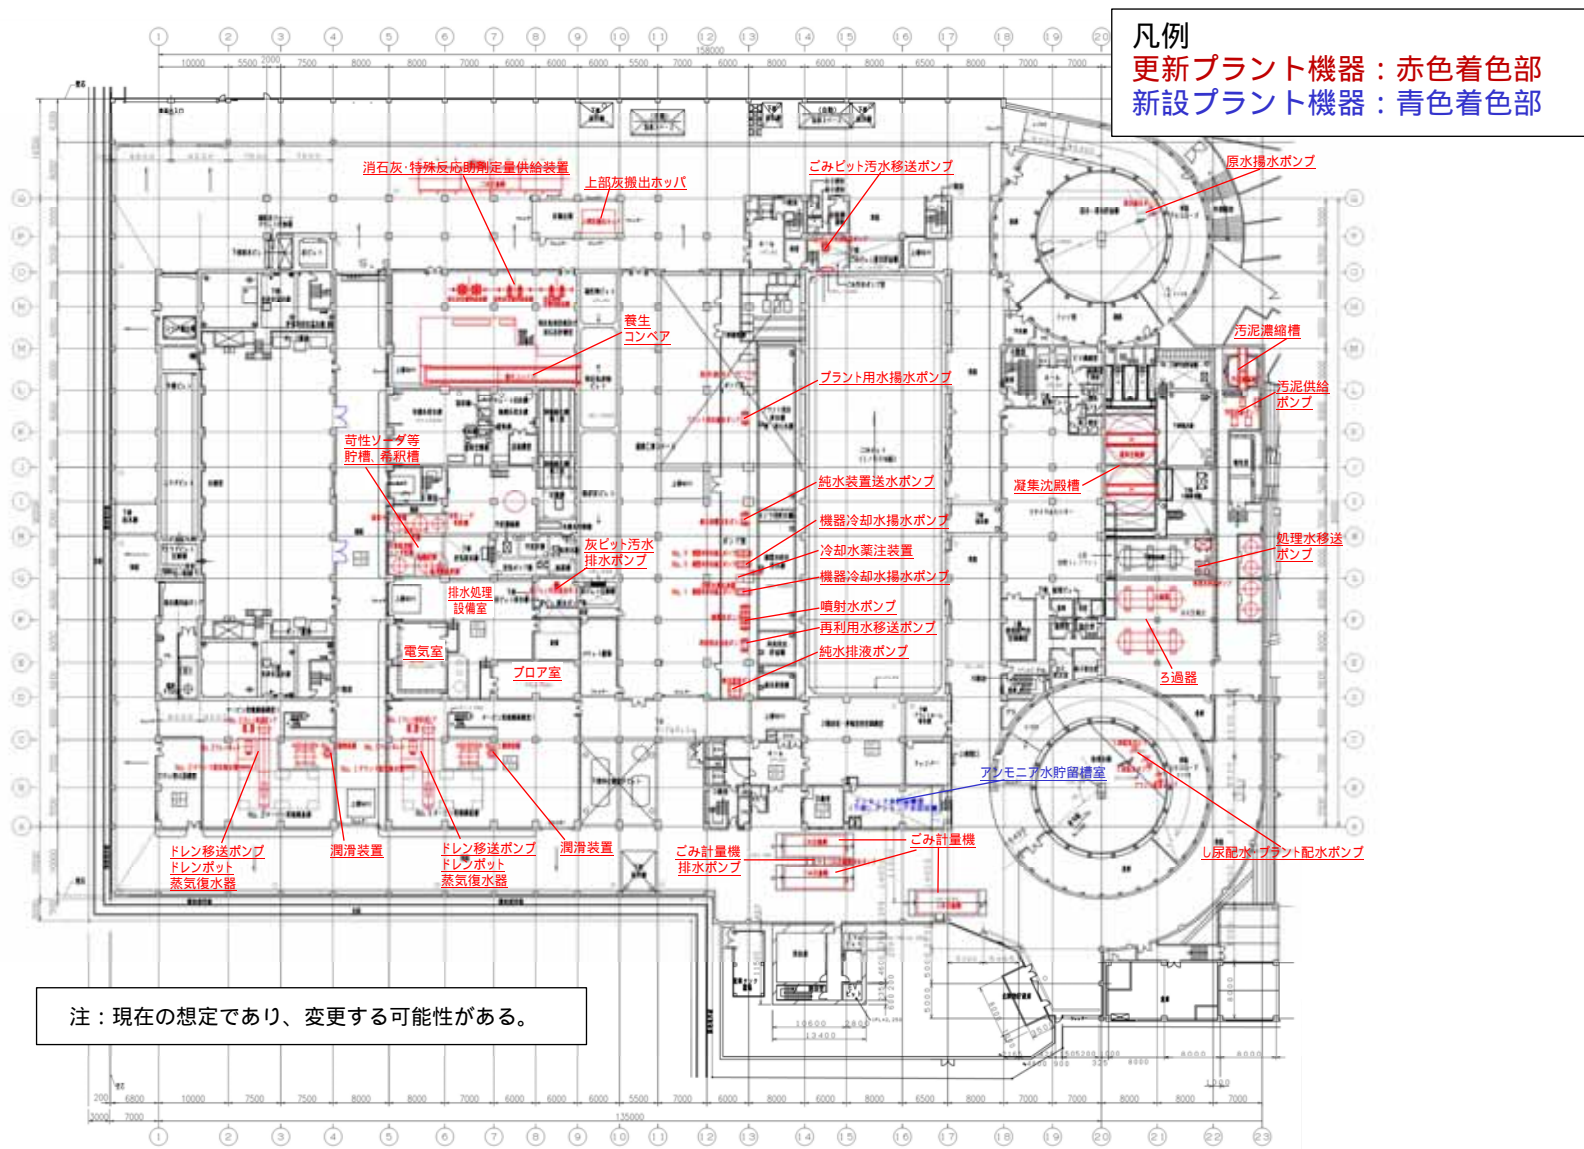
(1) 設備機器の更新箇所(1階平面図)
